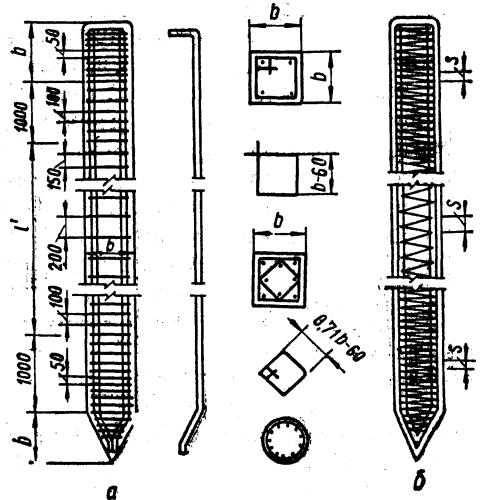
Железобетонные сваи: а — квадратного сечения; б — круглого сечения.
